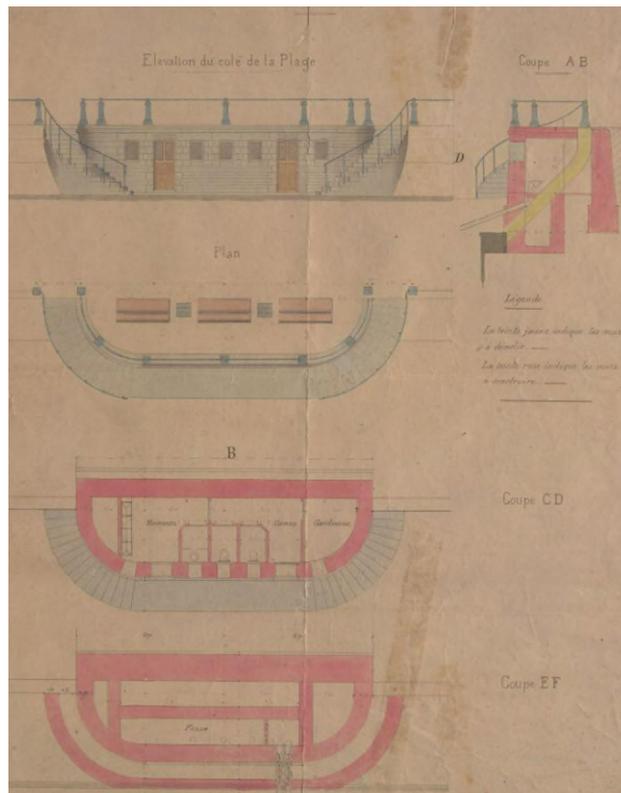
Plan récupéré sur le site des archives des Sables d'Olonne
